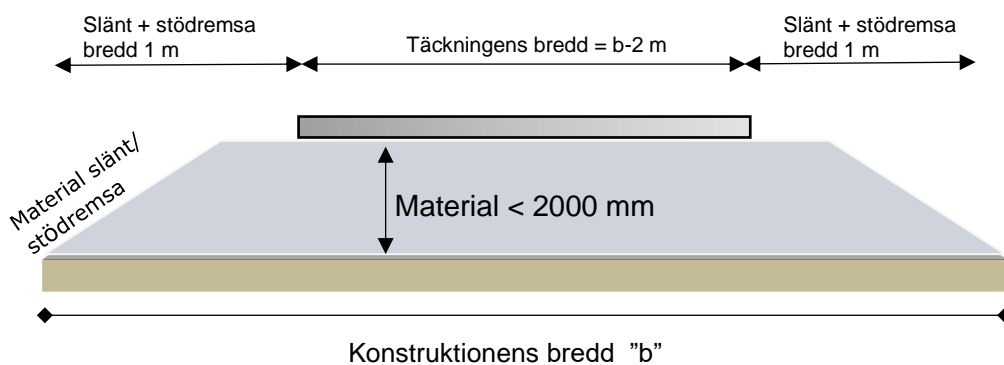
Tvärsnitt genom konstruktion och lagerföljd för typfall utan (asfalt)täckning.
